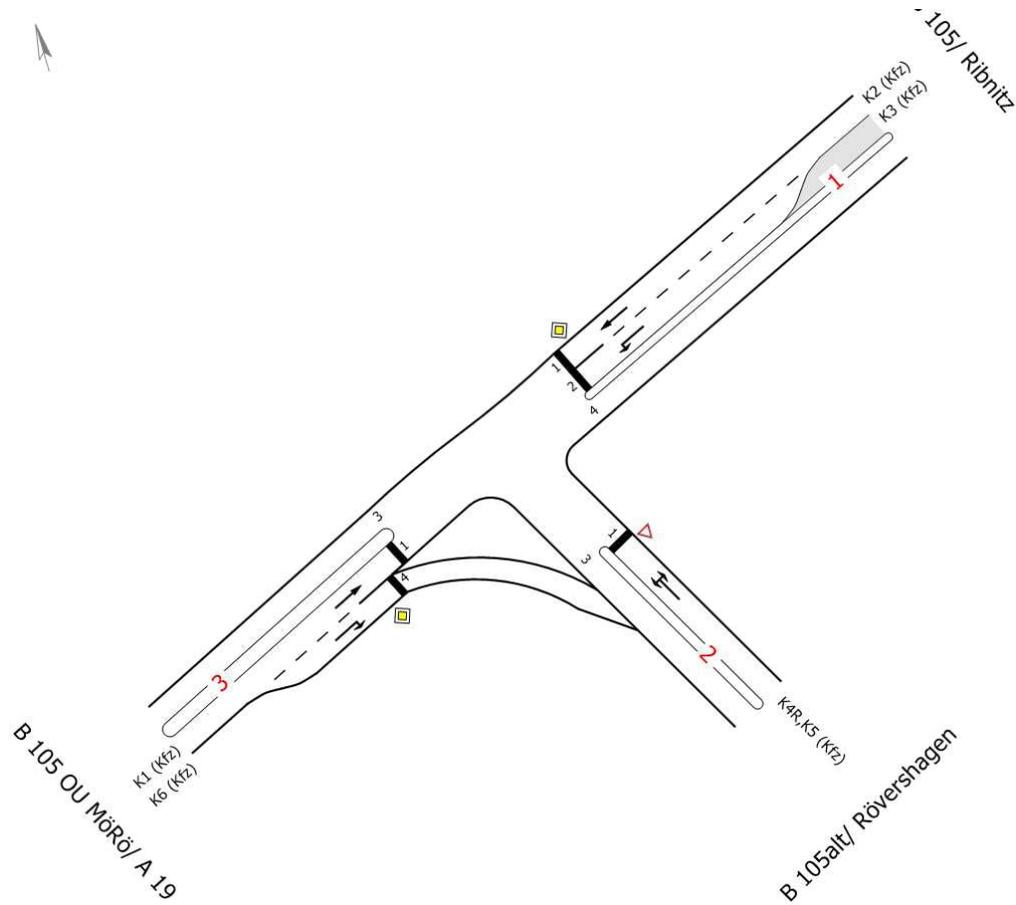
Knotenpunktschema KP1000 – Plan-Ausbauzustand Planfall 8-2
